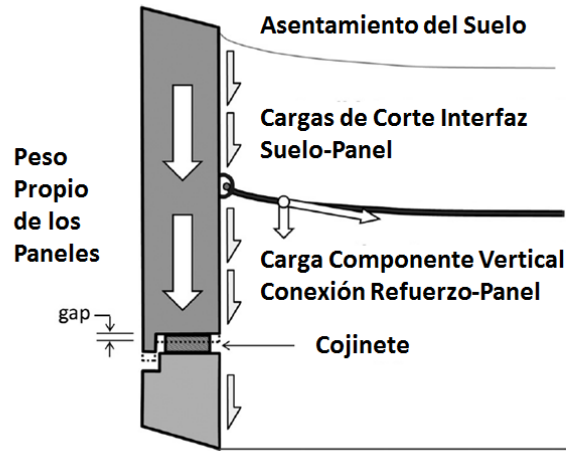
Descomposición de cargas verticales aplicadas a la fachada del muro (Damians et.al 2016).
